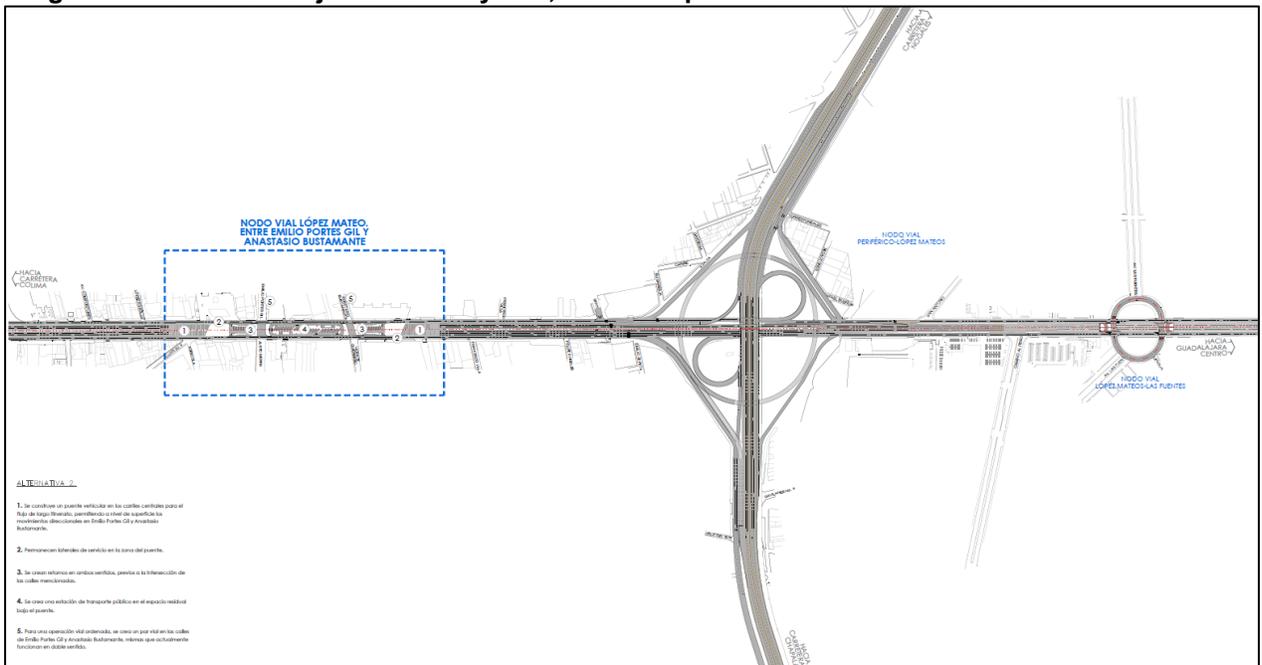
Planta de Conjunto del Proyecto, Nodo “López Mateos – Emilio Portes Gil”
